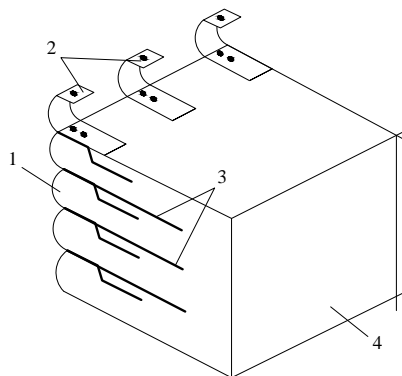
Схема підпірної стінки з армованого ґрунту з облицюванням та армуванням з геотекстилю: 1 – облицювання; 2 – скоби; 3 – армувальний матеріал; 4 – ґрунт
